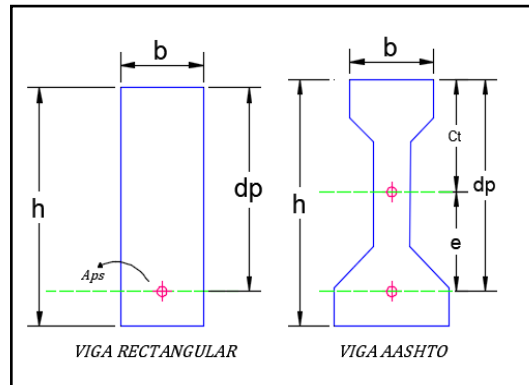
Secciones transversales para una viga rectangular y una viga AASHTO
